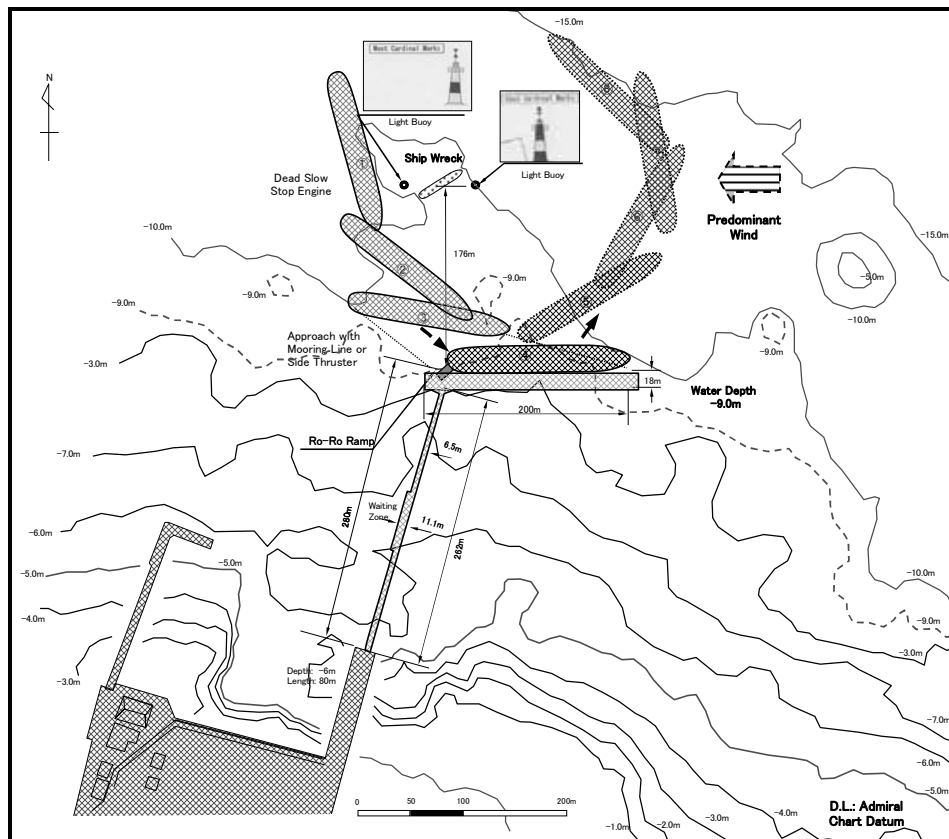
係留栈橋及び連絡橋の平面配置の概要
